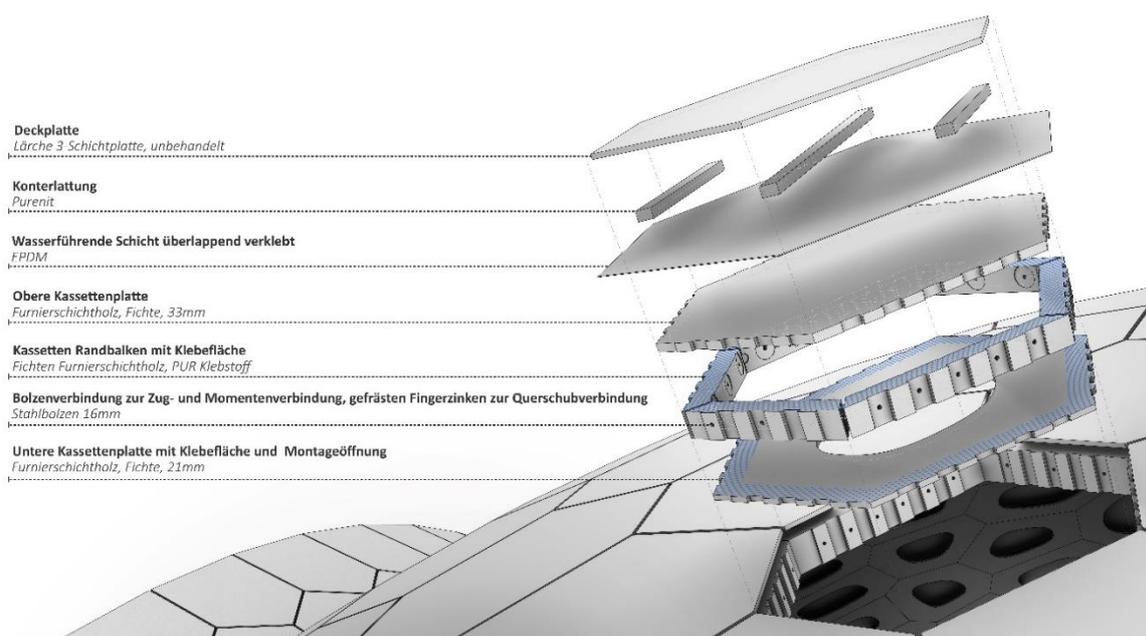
Explosionszeichnung eines Holzkassettensegments des BUGA Holzpavillons.
